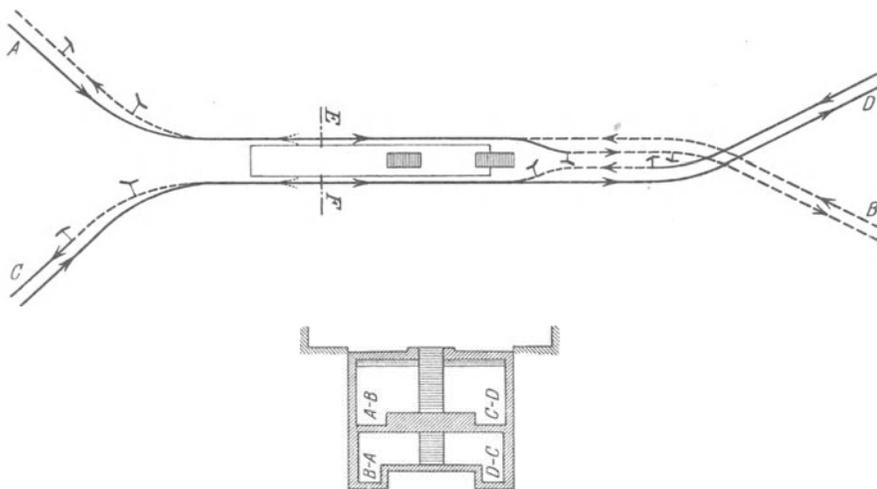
Zweigeschossige Kreuzungsstation mit Richtungsbetrieb.
